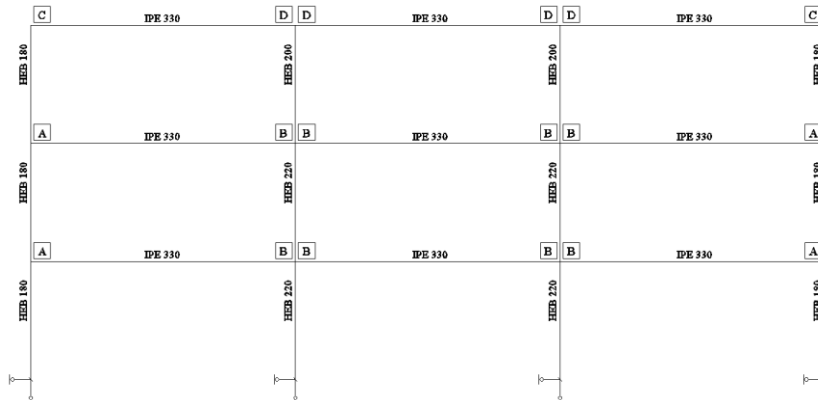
Configuração das ligações adotadas para o pórtico em estudo
